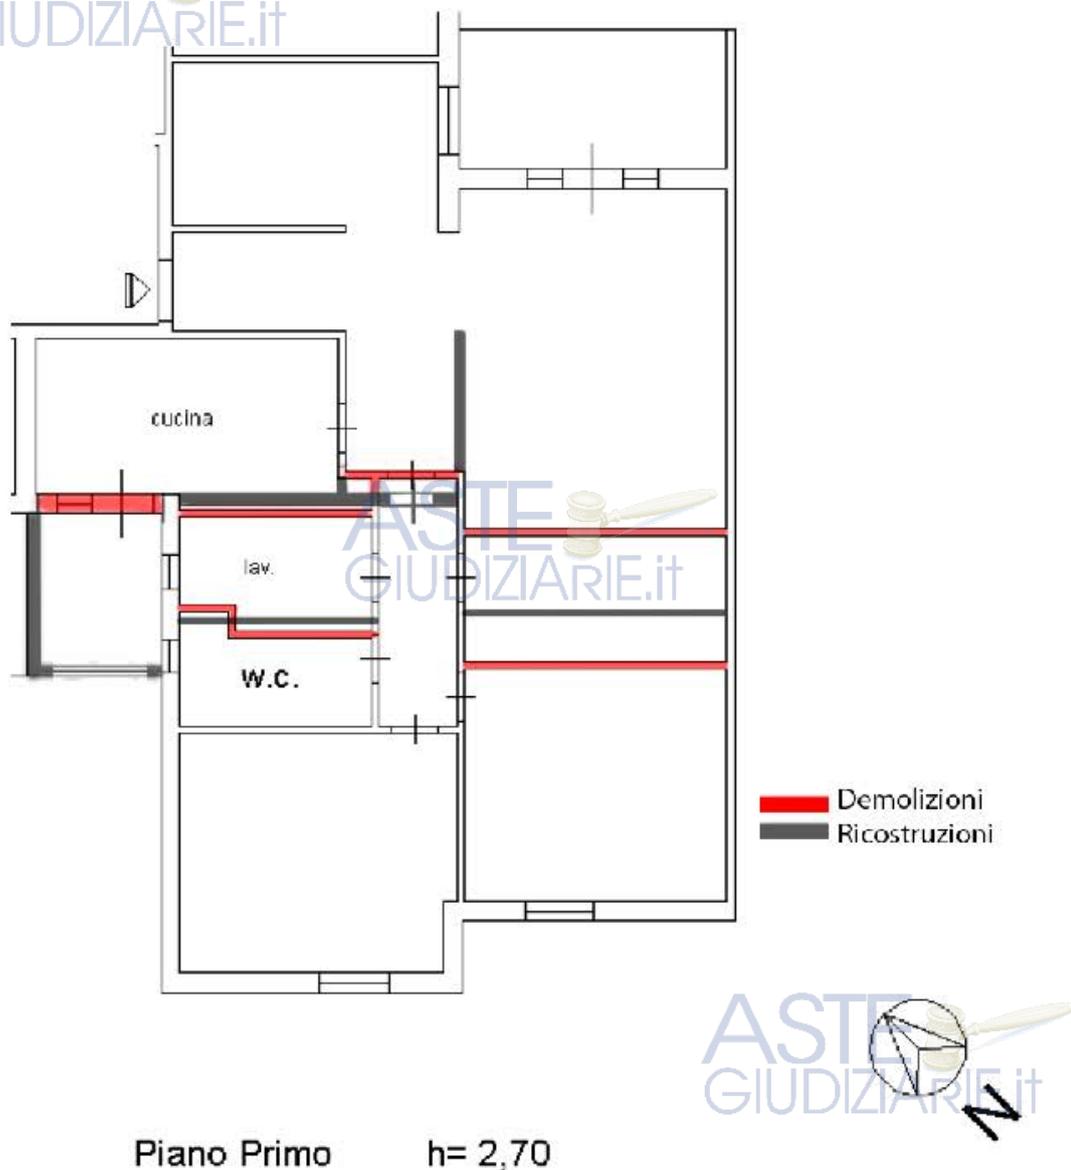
individuazione difformità planimetria catastale - stato di fatto
